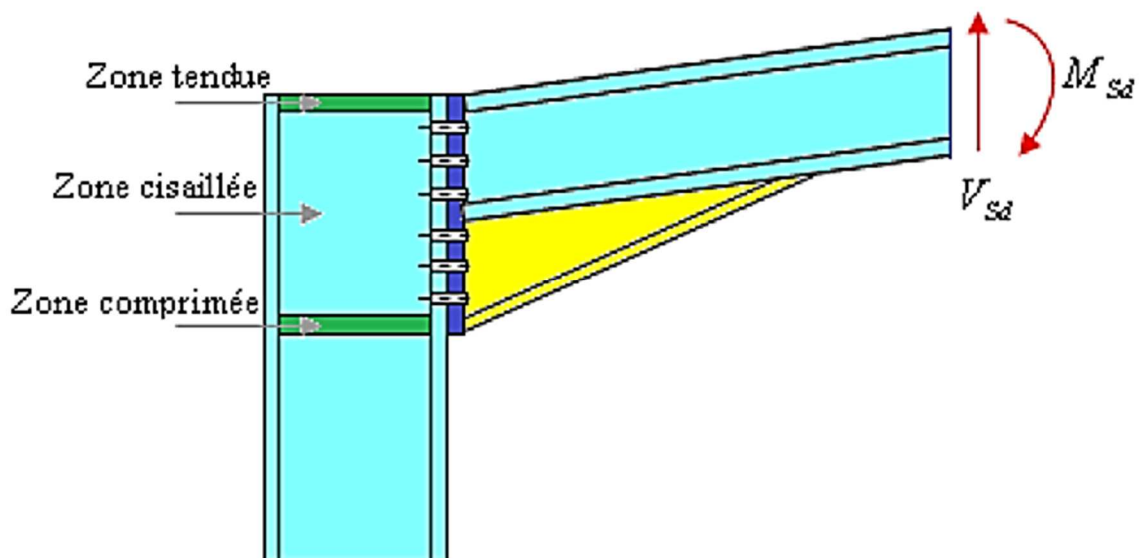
Représentation de l'assemblage poteau-travers.
